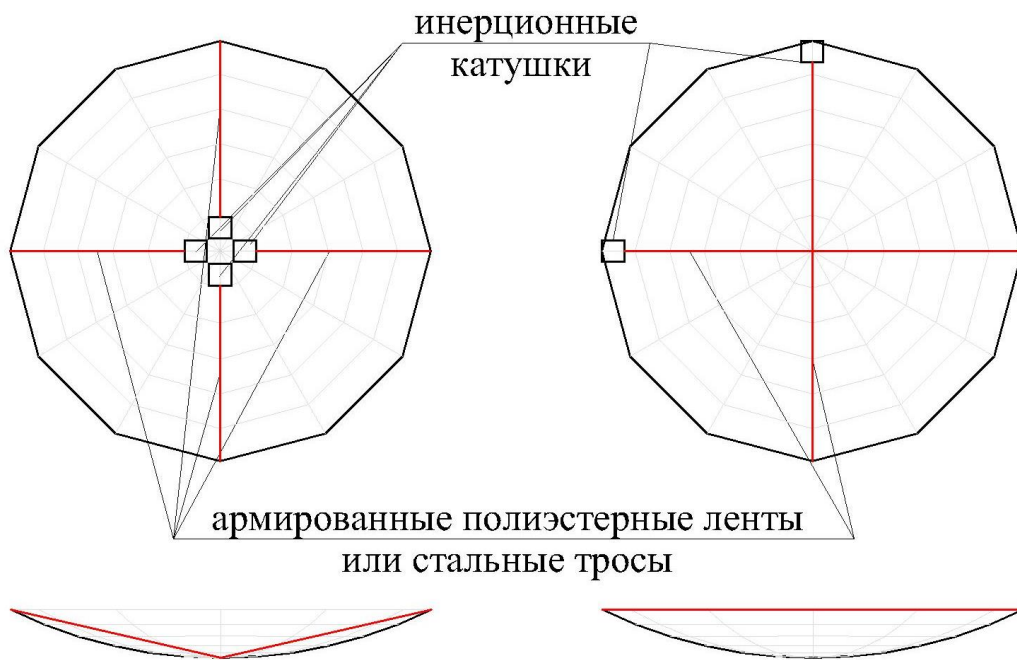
Схема установки гасителя в конструкцию купола локатора
